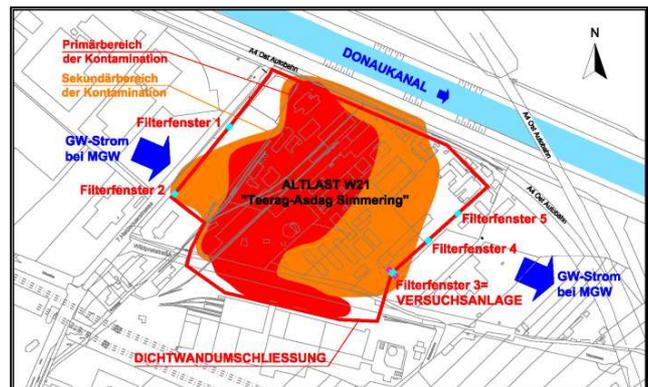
Lageplan der Sicherungsmaßnahmen inkl. Primär- und Sekundärkontaminationszone
